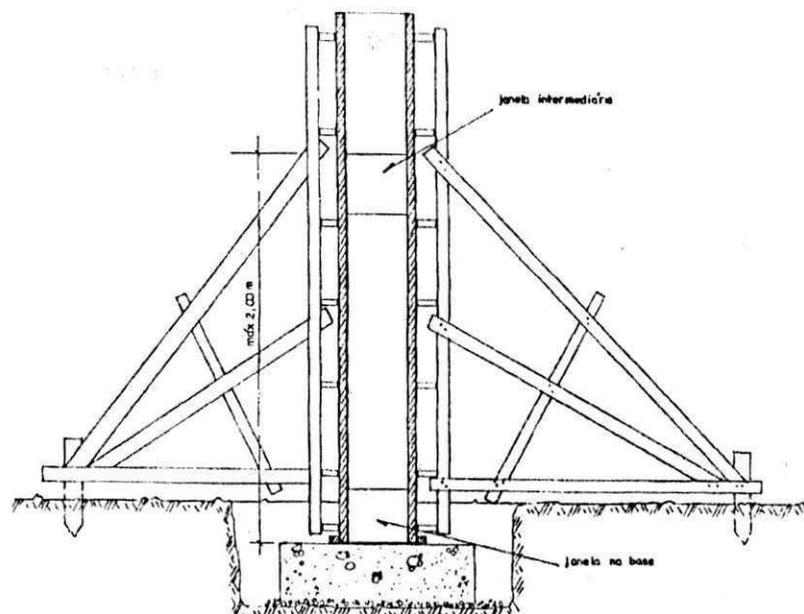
Detalhes do escoramento e contraventamentos em pilares bem como das janelas
